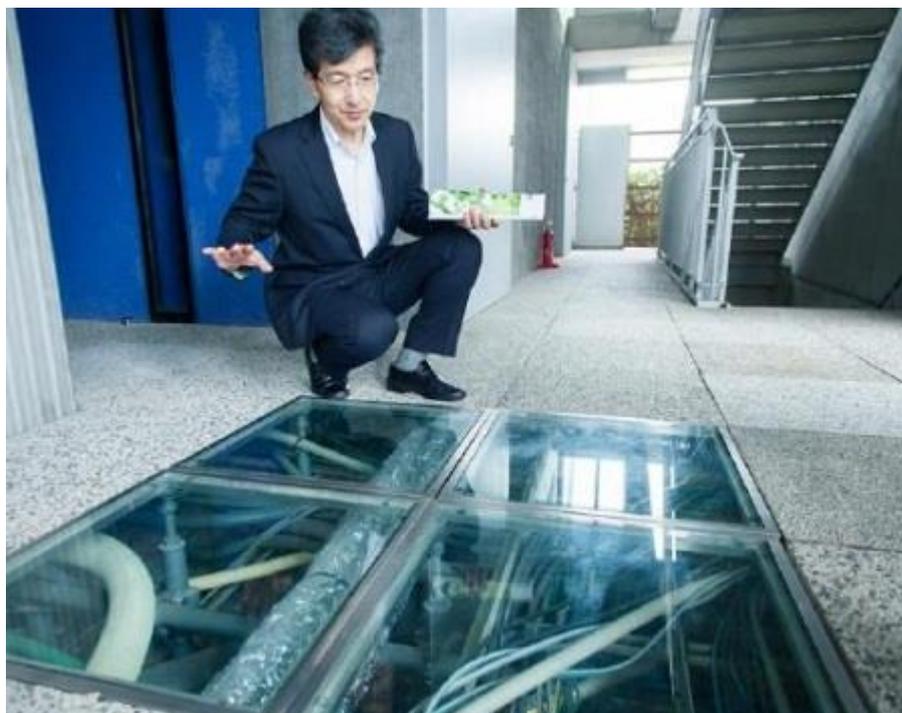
Next 21 - Sistema de canalização acessível a partir da zona de ‘rua’ (fonte: FERREIRA, 2021, p. 48)
